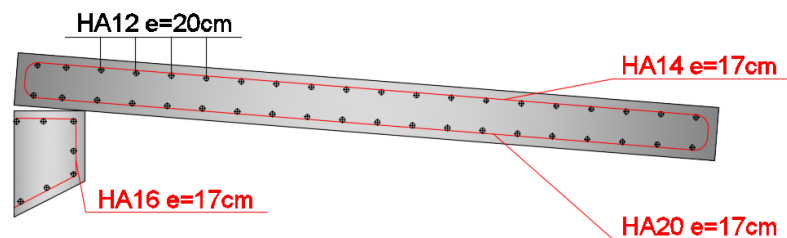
Ferrailage de la dalle de transition + Corbeau.
